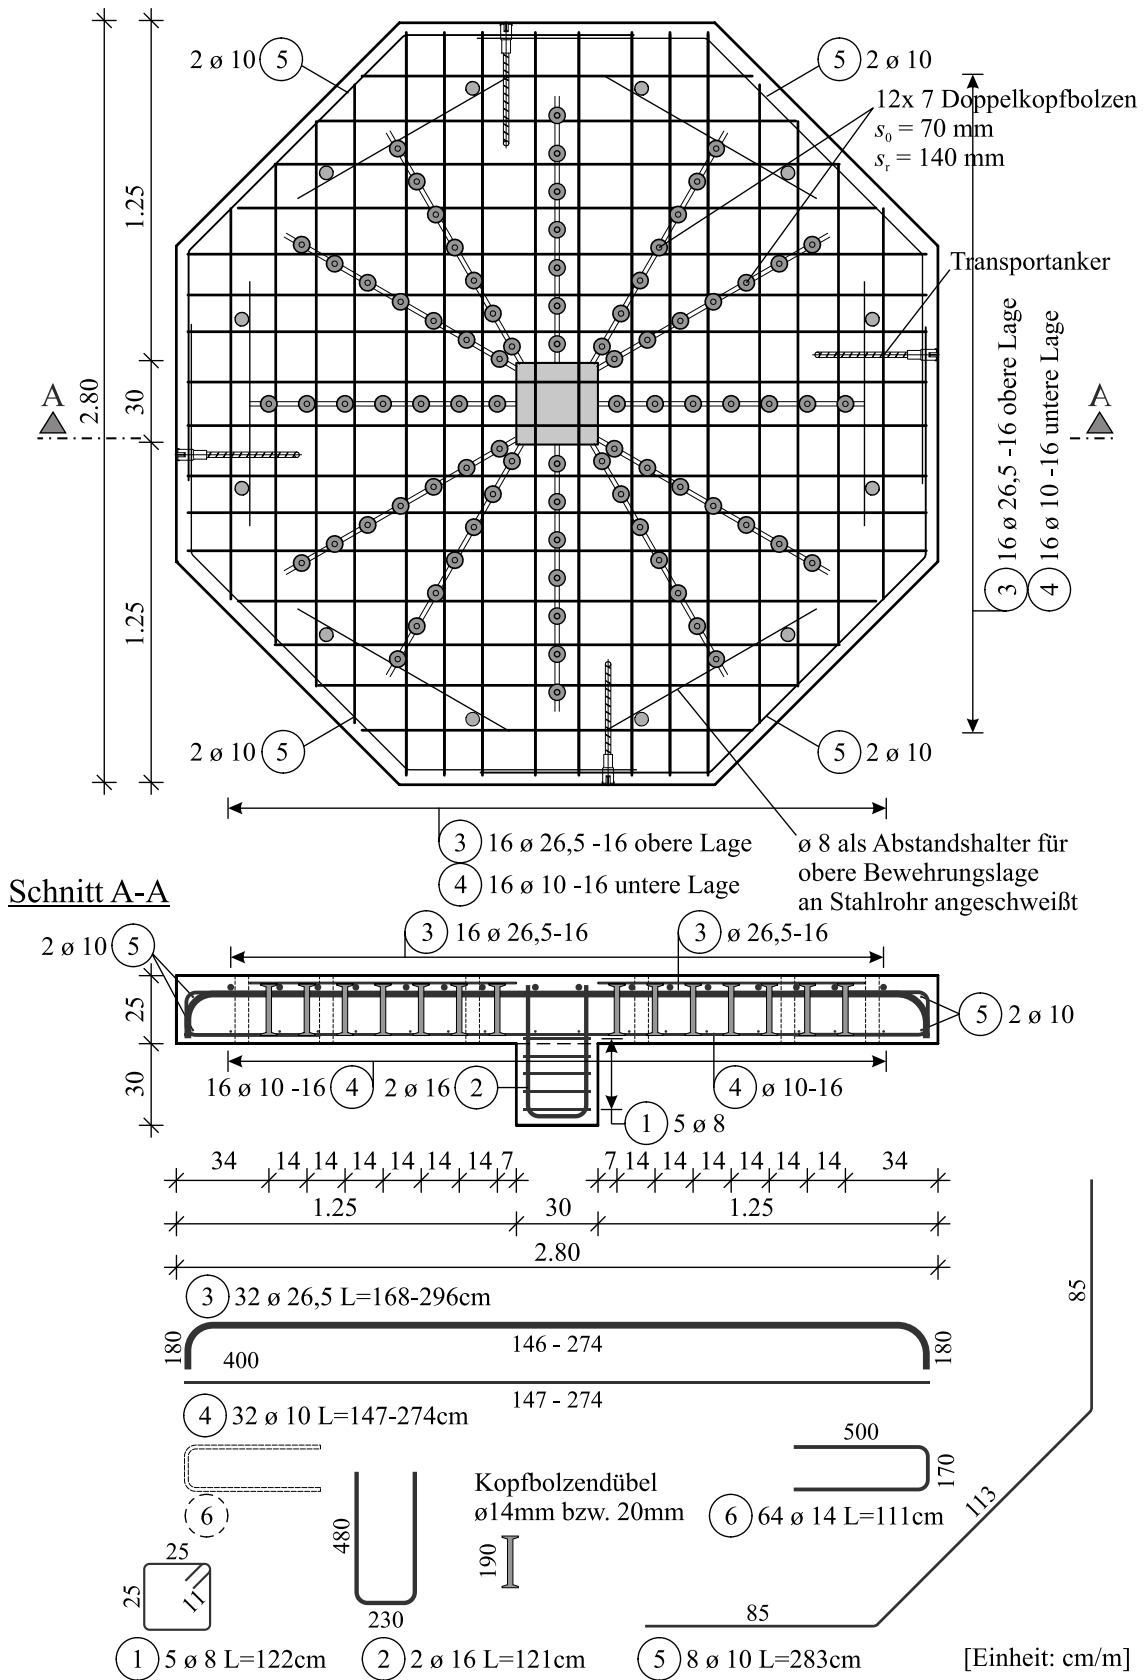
Bewehrungsplan der Versuchskörper M0-25-1.75-D20, M3-25-1.75-D20/D14
